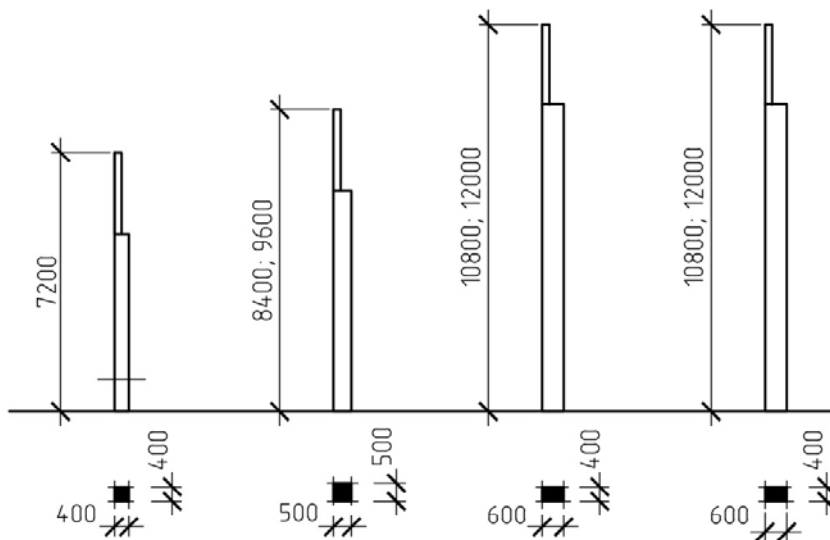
Железобетонные колонны продольного фахверка сплошного сечения
